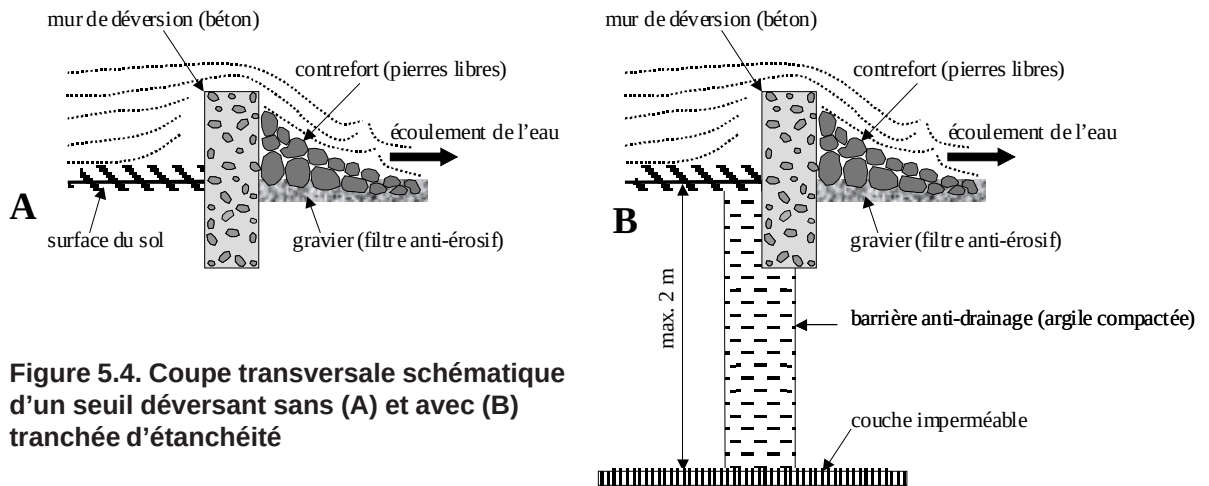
Coupe transversale schématique d'un seuil déversant sans (A) et avec (B) tranchée d'étanchéité
